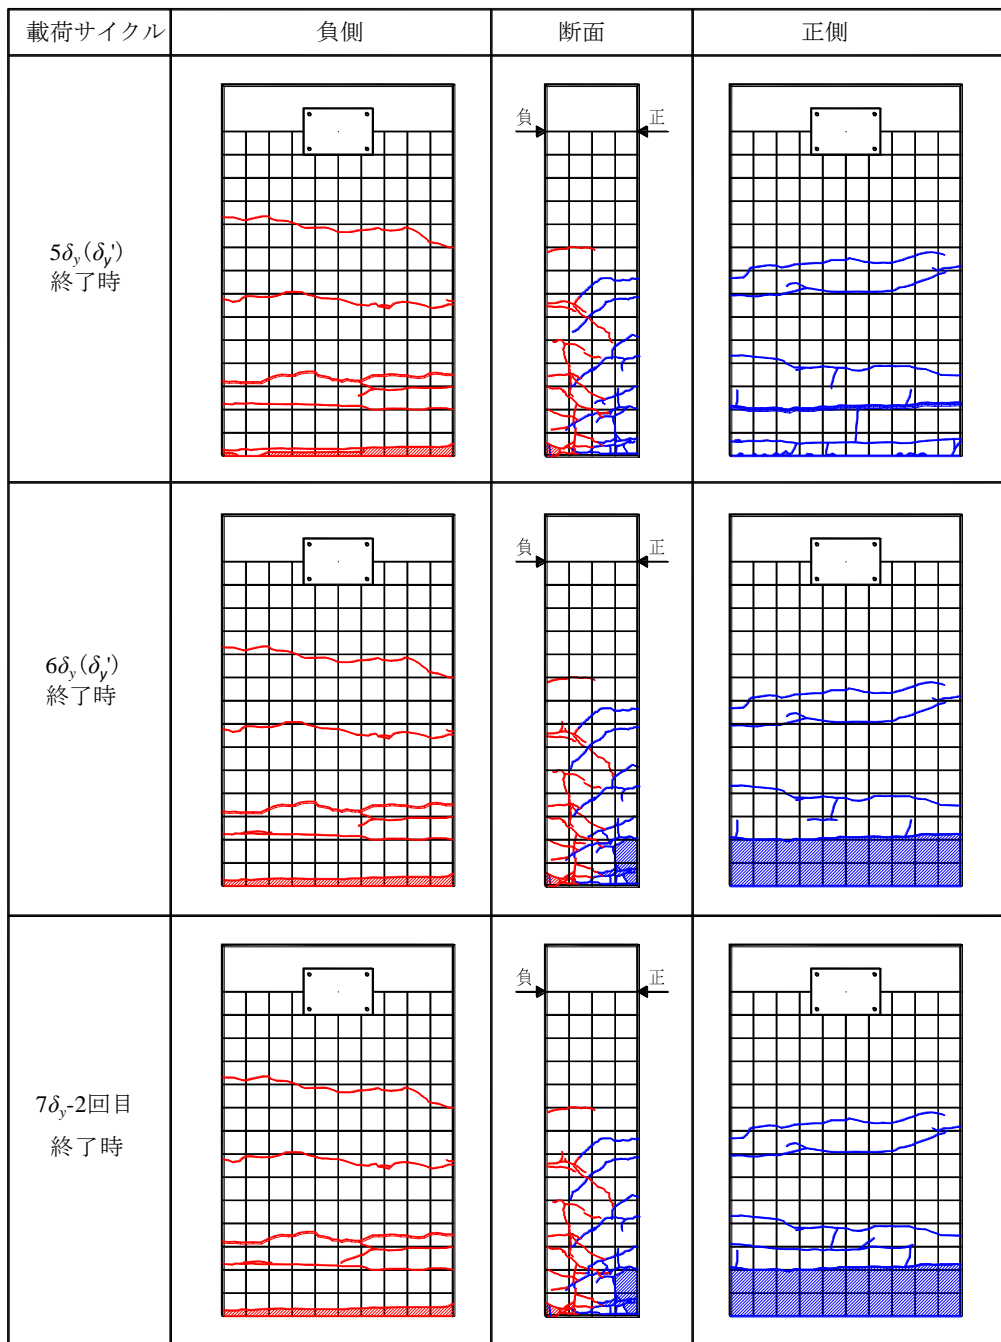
ND25A 試験体ひび割れ図 (5 δ_y ~7 δ_y)
